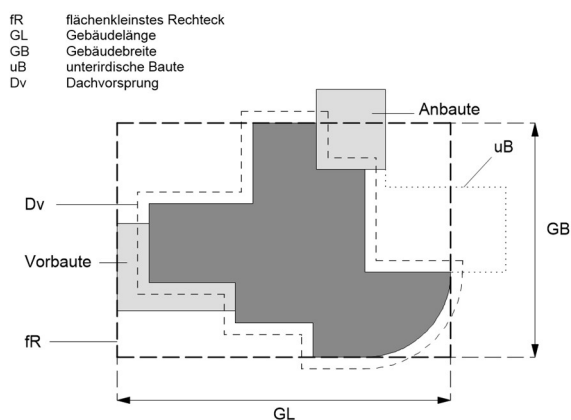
Flächenkleinstes Rechteck für Gebäudelänge und -breite über gestaltetem Terrain
